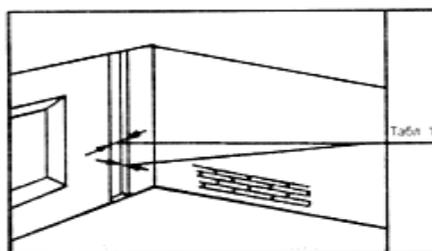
Нанесение отверстий и борозд для прокладки трубопроводов
